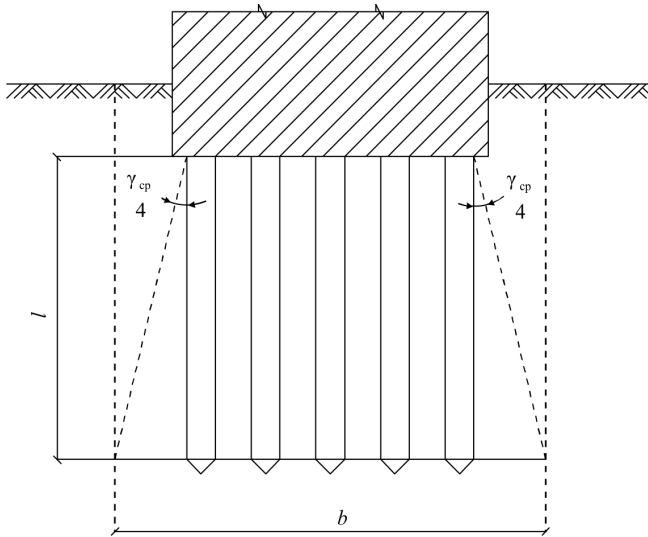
Схема для визначення розмірів умовного пальового фундаменту
